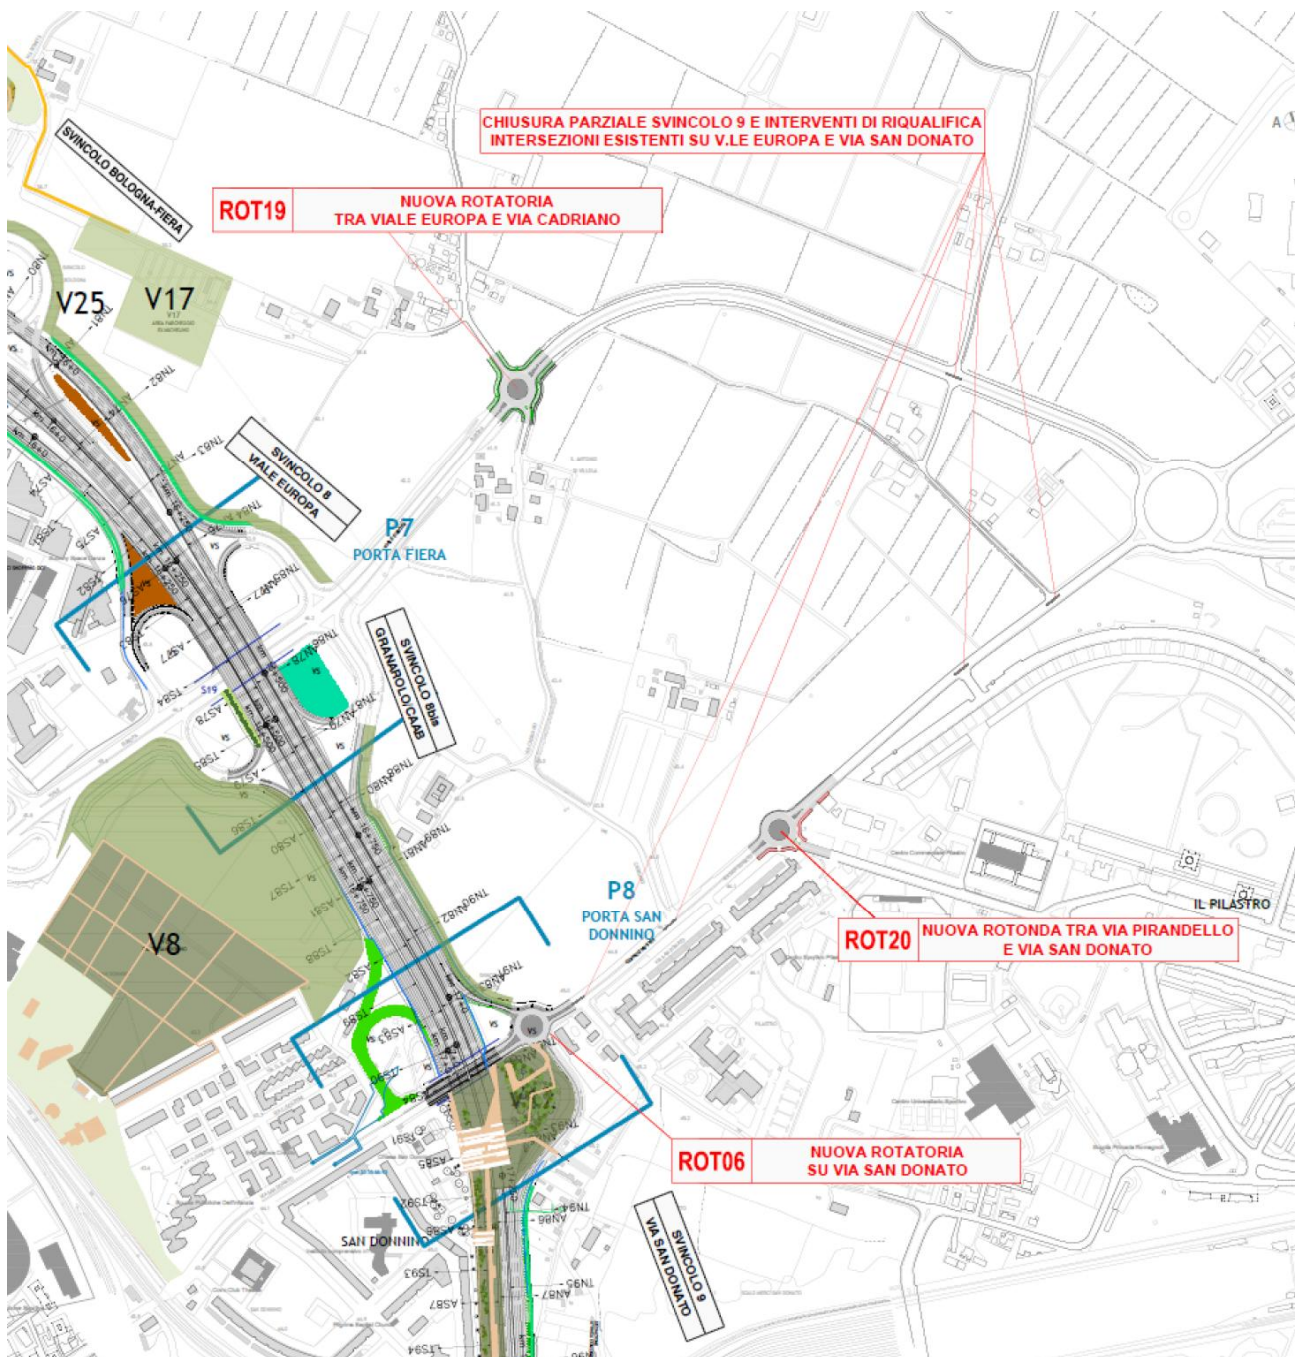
Planimetria Progetto approvato – Chiusura parziale svincolo 9
